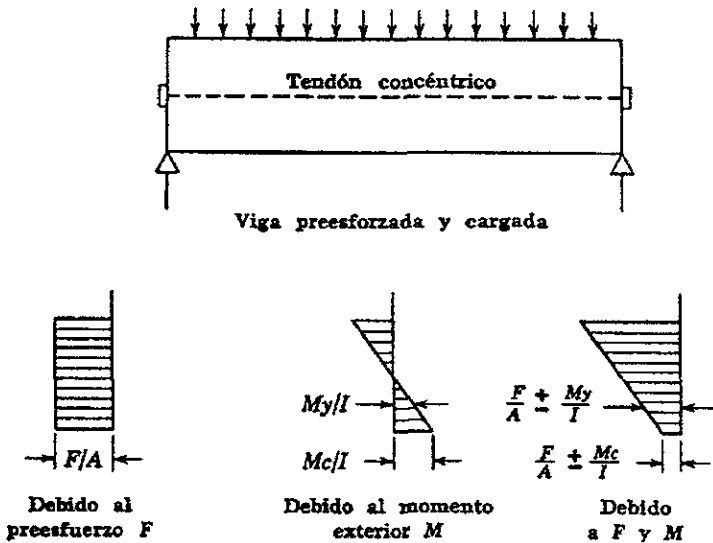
Distribución del esfuerzo a través de una sección de concreto preesforzado concéntricamente.
